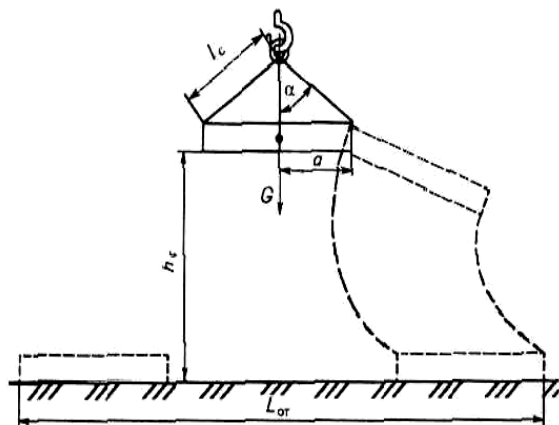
Схема определения границ опасной зоны при обрыве стропа грузоподъемной машины:
